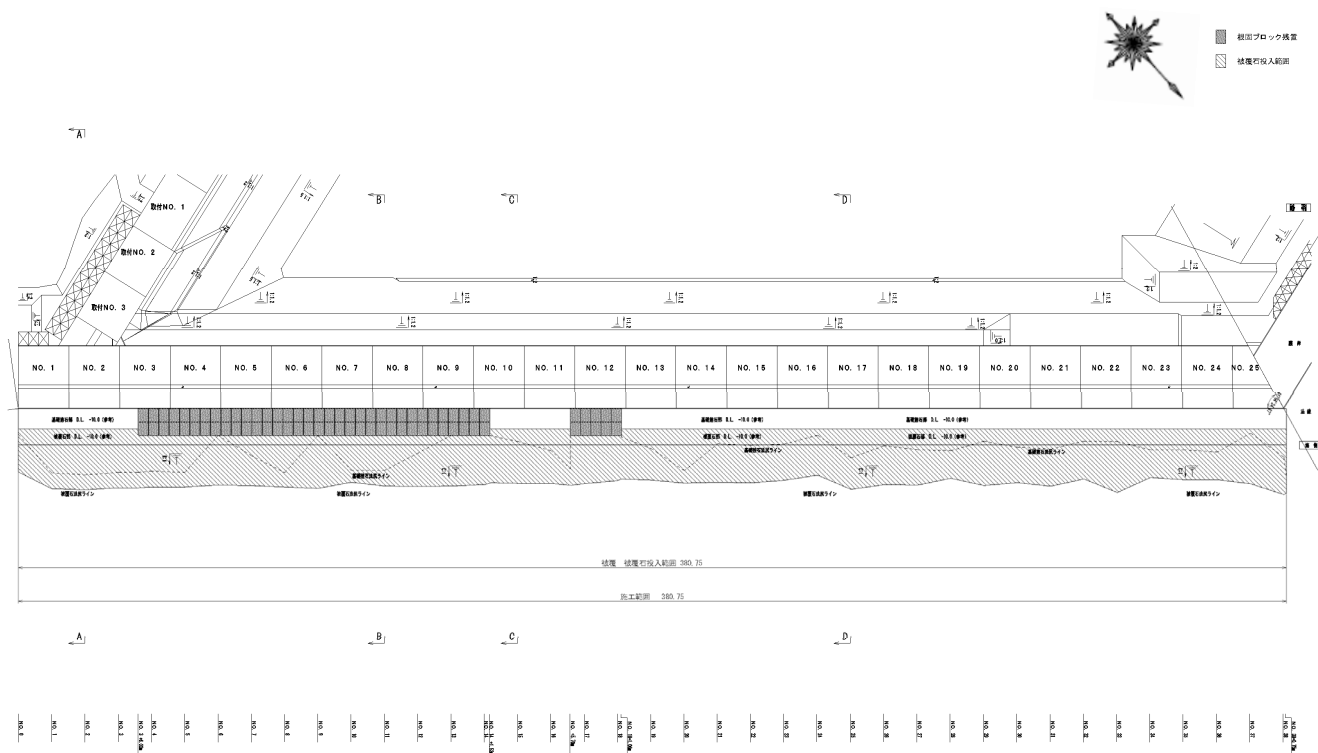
No.1 外港地区防波護岸平面図（復旧後）_復旧平面図（2）
